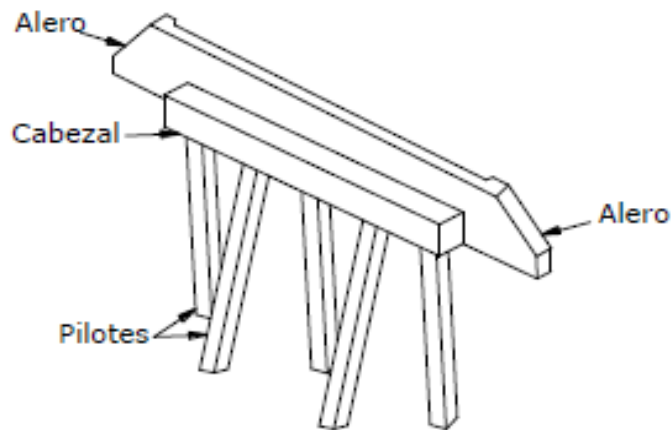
Estribo de caballete sobre pilotes con aleros cortos
